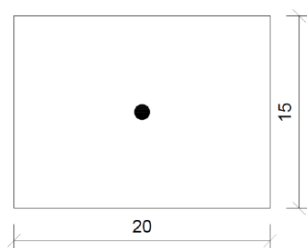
Corte transversal de um pilar ilustrado a vermelho na Figura 44
